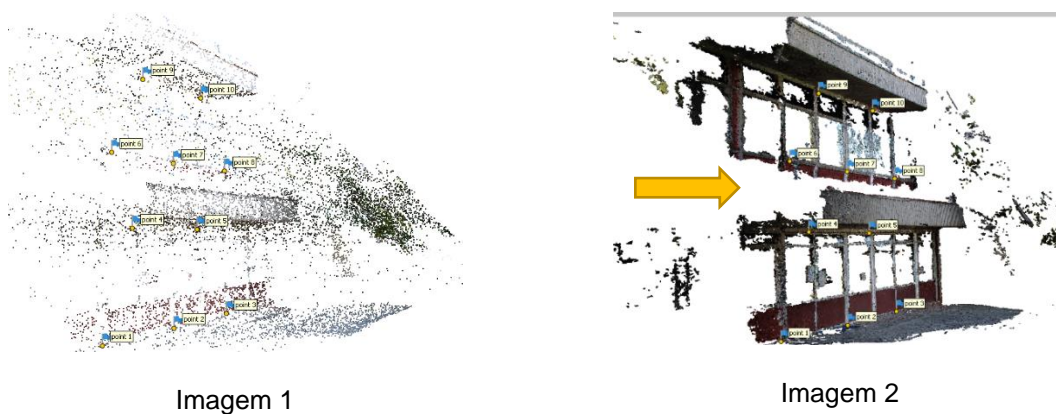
Fotogrametria terrestre – Fachada da Poli-USP – Vista frontal do modelo gerado após processamento de fotogrametria pela ferramenta Agisoft Metashape.
